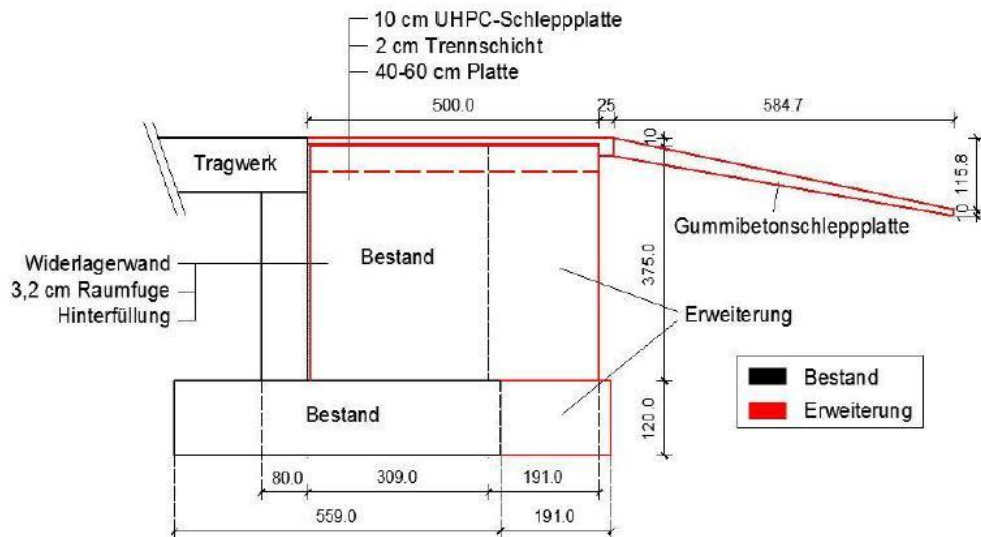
Ausführungsdetail Gummibetonschleppplatte [18]
